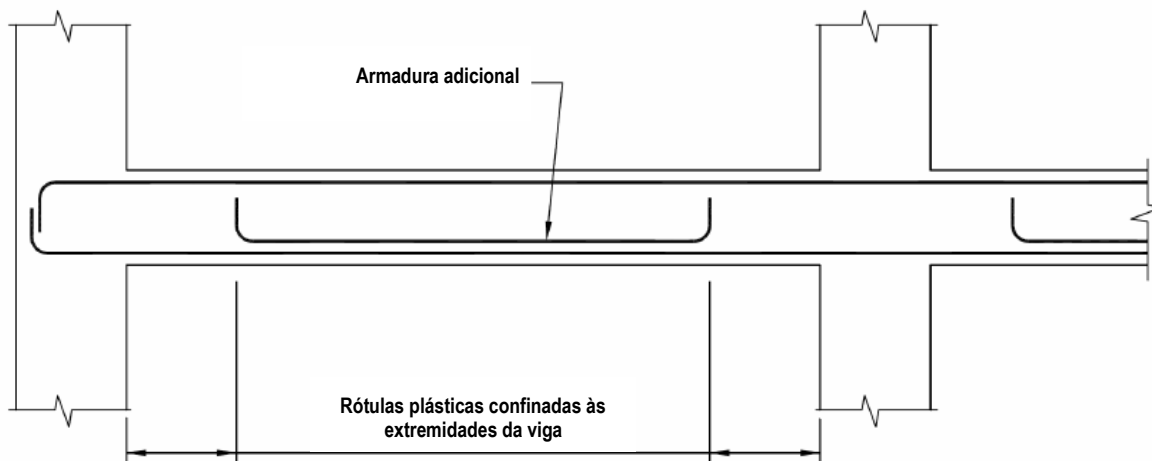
Pormenorização de armadura para prevenir a formação de rótulas unidireccionais [NZS3101 (2006)]
